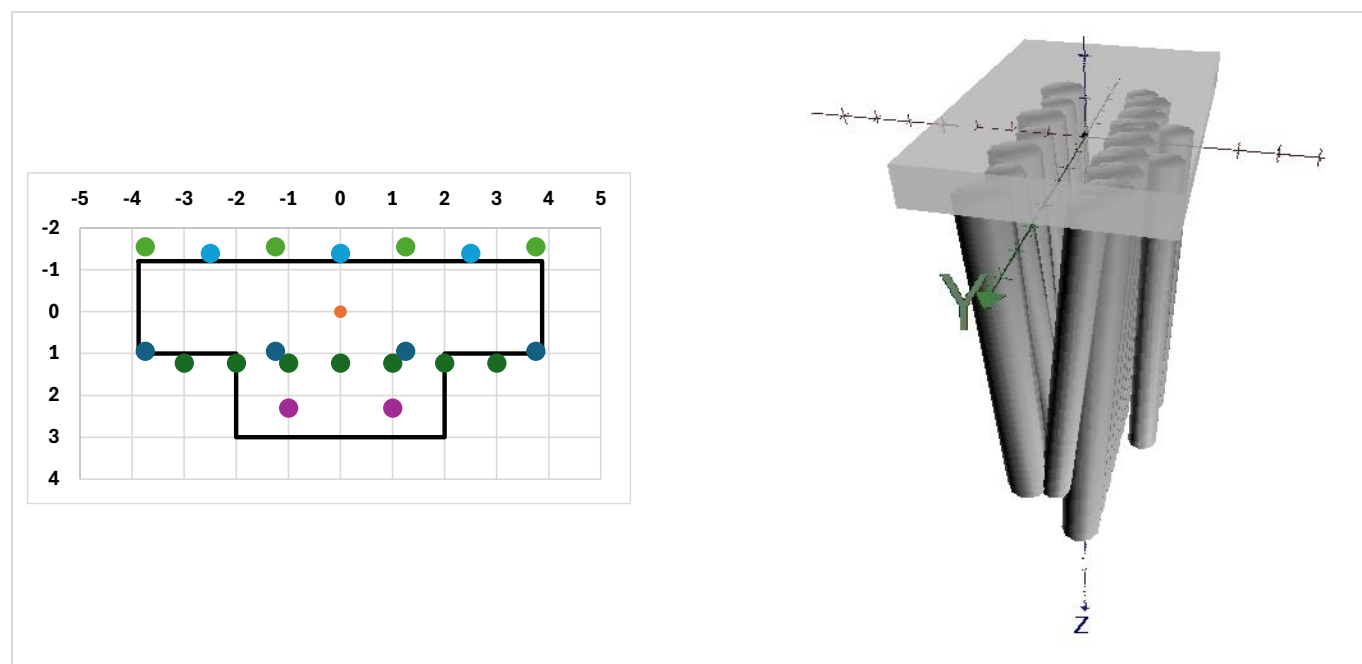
Calepinage des colonnes de jet grouting et modèle de la semelle de la fondation C (Conciergerie)
